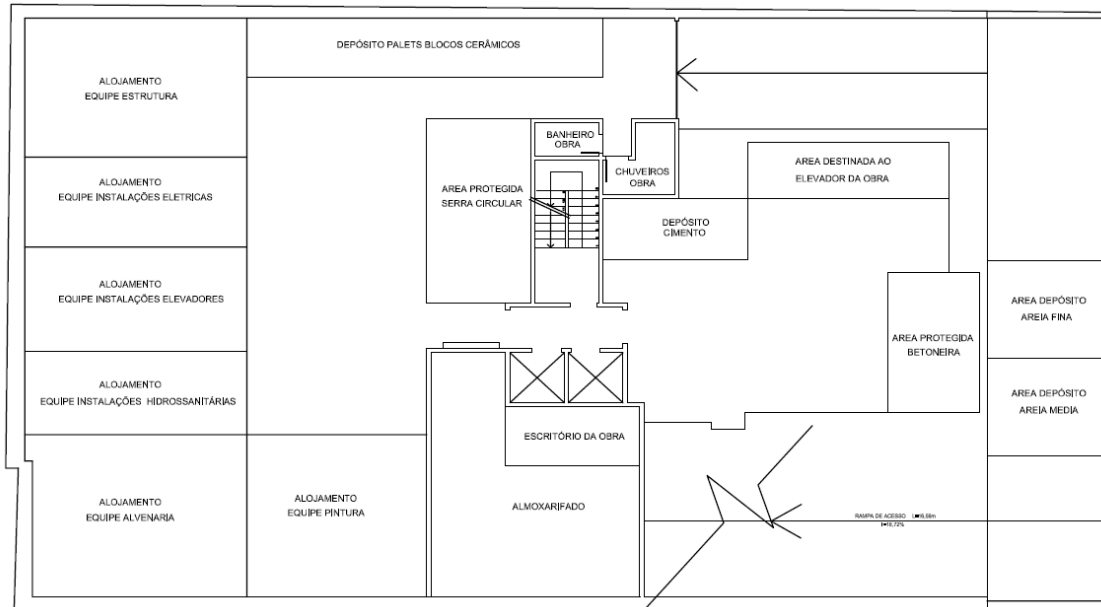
Croqui do canteiro de obra projetado no pavimento térreo
